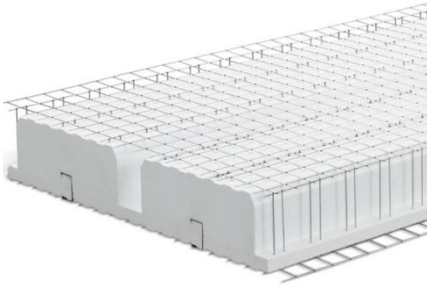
Paneles para losas y cubiertas. Fuente: Grupo de Trabajo.
